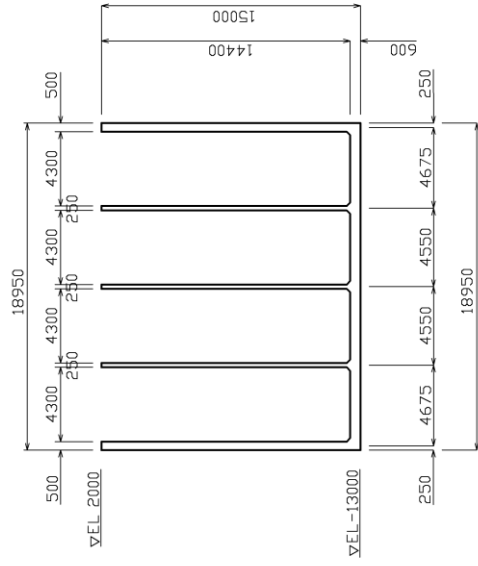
防波壁 (波返重力擁壁) のケーソン構造図(④-④断面) (断面図)
